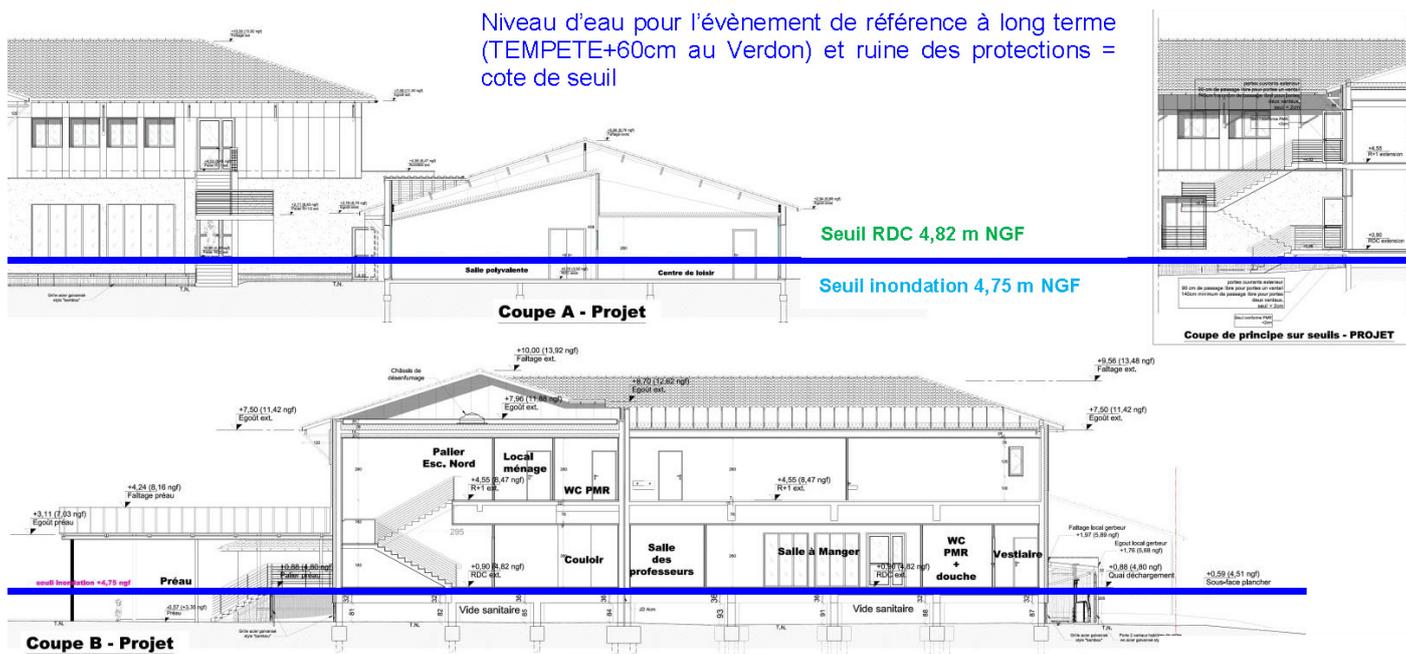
Coupes du projet, seuils de plancher et d'inondation pour l'événement Tempête 99+60cm au Verdon - Coupes C+M architectes
